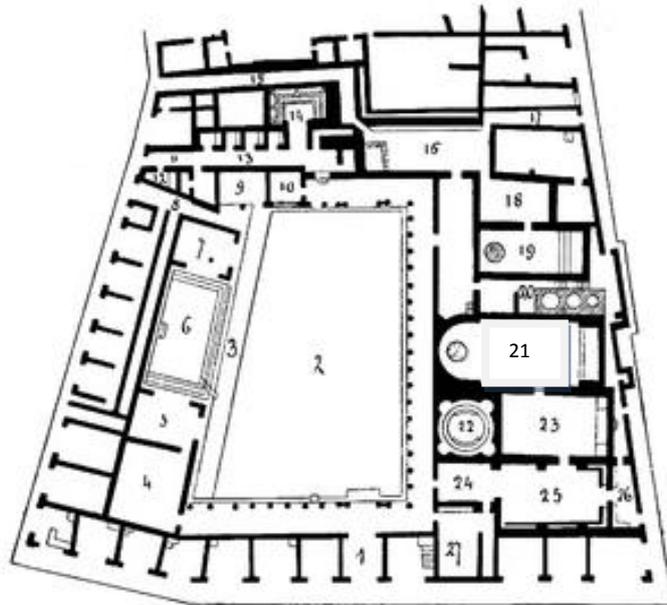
Pianta delle terme Stabiane a Pompei nella loro fase del II a.C.
